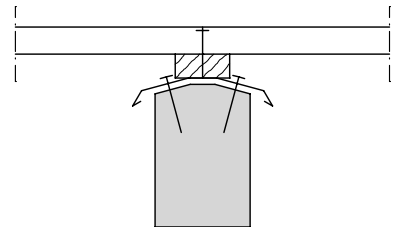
Bohlenrost mit unterseitiger Längsbohle Abdeckblech mit Haften oder Dichtschauben
